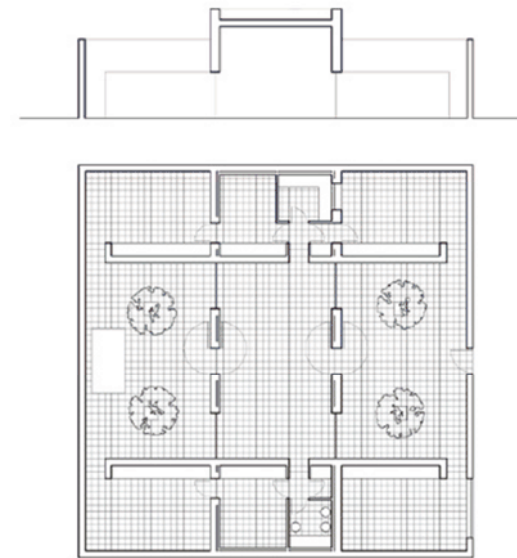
/ Planta arquitectónica de casa Gaspar/ Alberto Campo Baeza/
